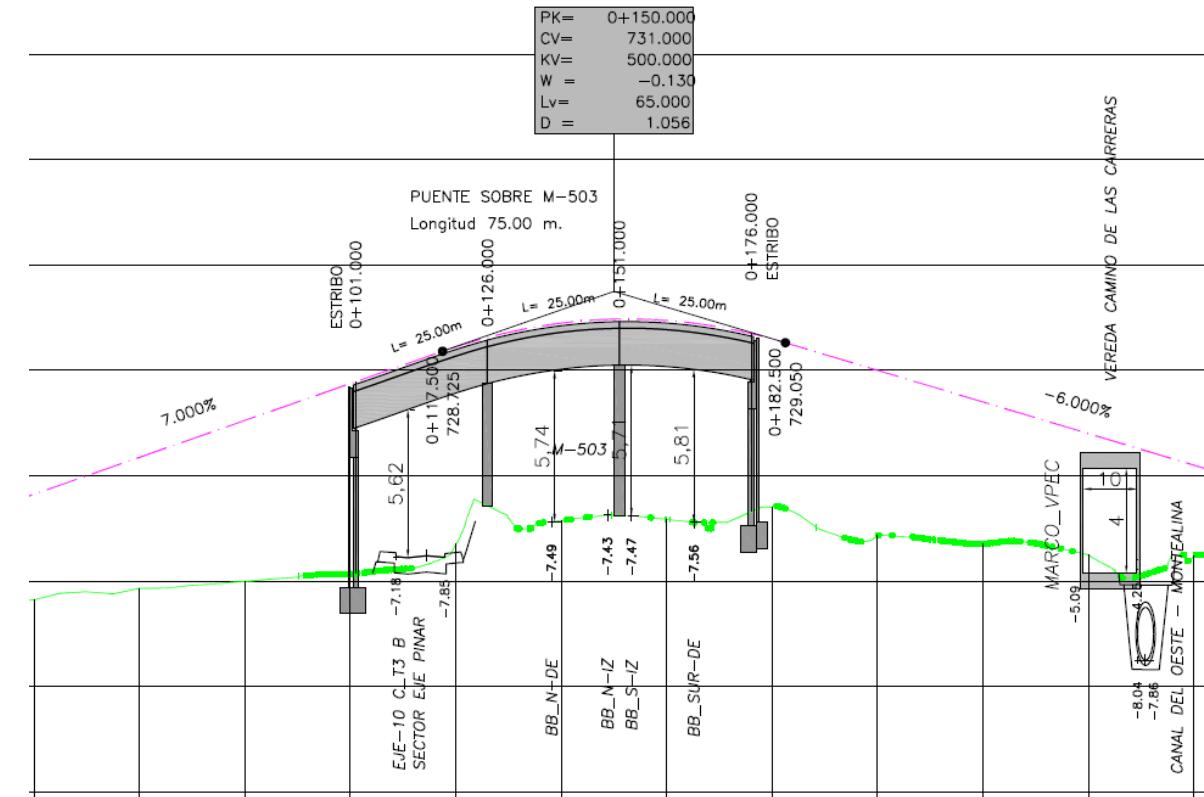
Perfil longitudinal ESTRUCTURA 6
